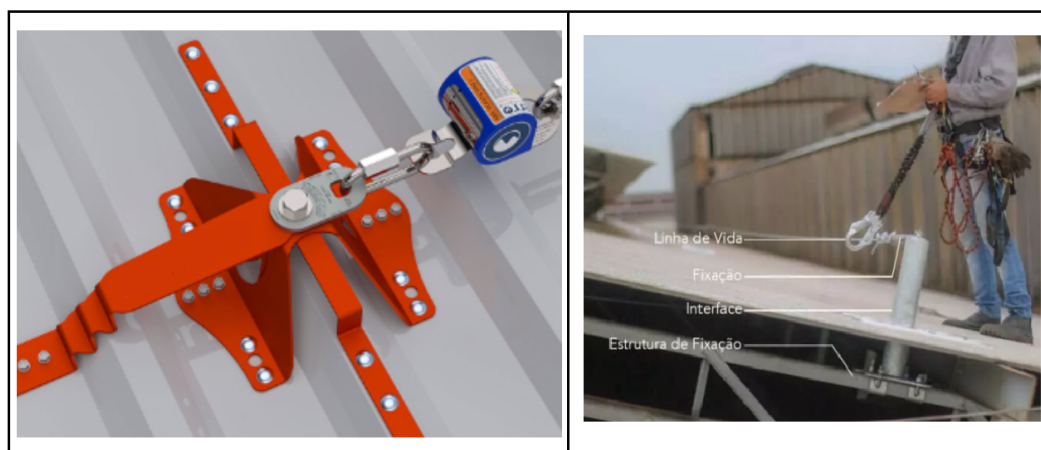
Pontos Ancoragem TIPO C (Fixação em Telha x Fixação em Estrutura)
